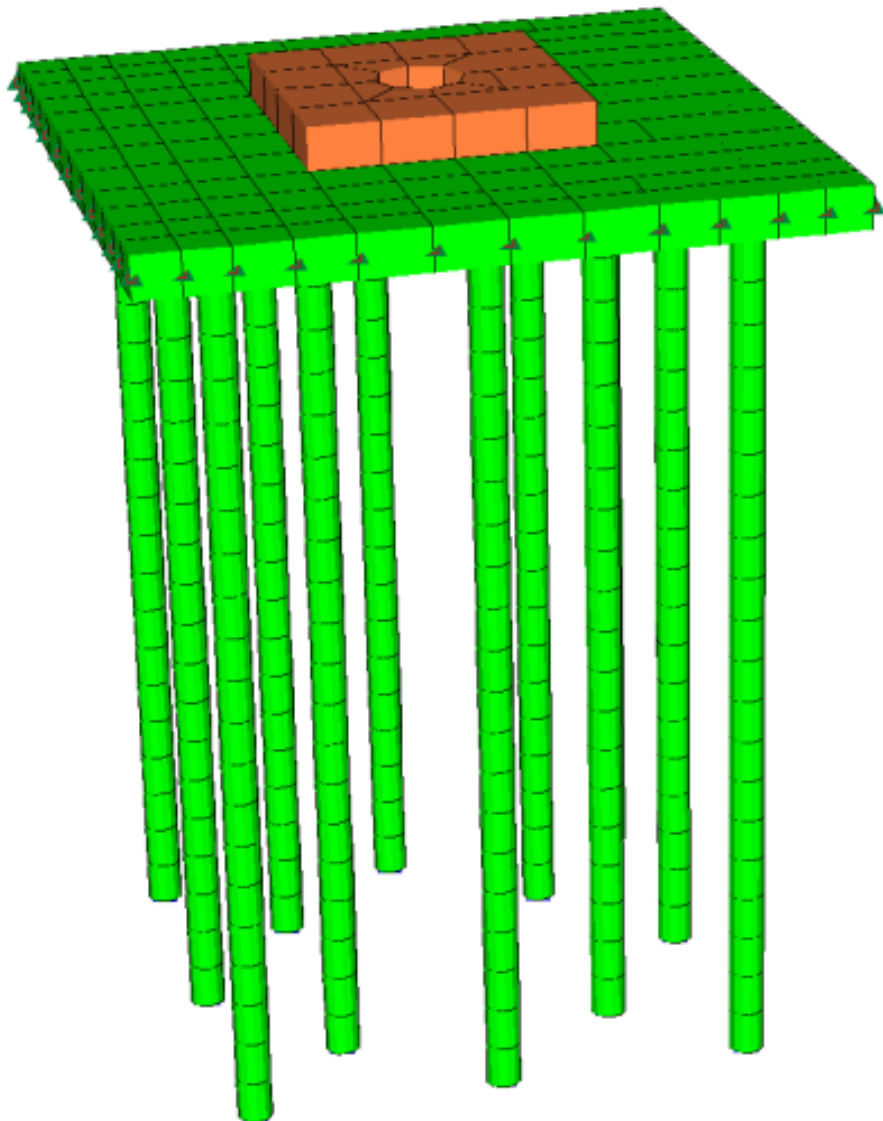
Schema assonometrico platea e pali di fondazione.
